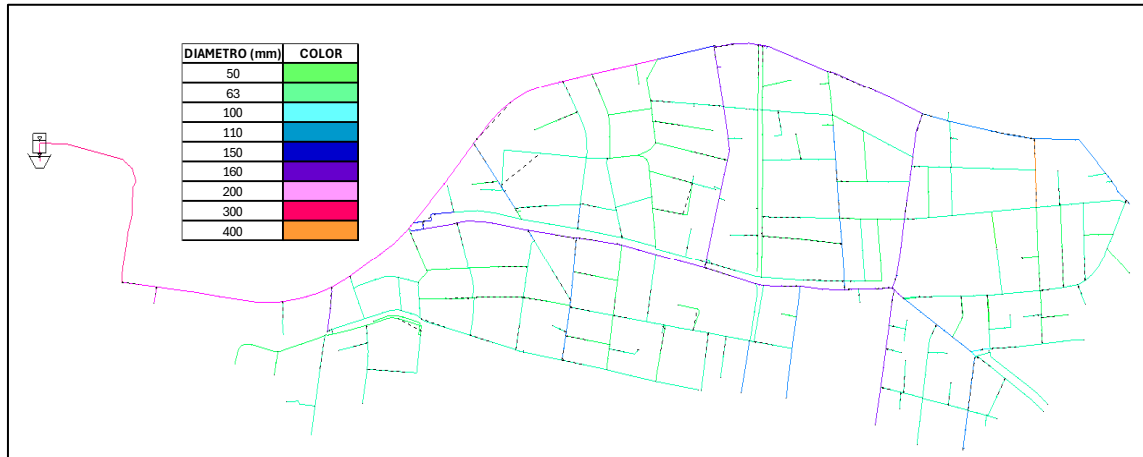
Delimitación planimétrica del sector 3.1 de la planta de tratamiento El Cebollar.
